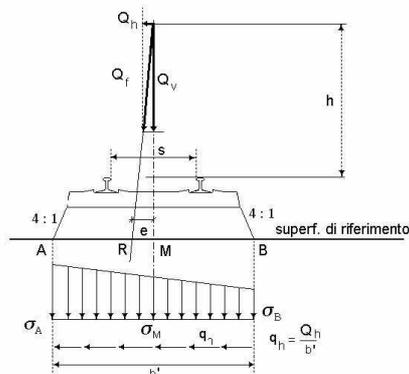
Distribuzione trasversale in rettilo delle azioni per mezzo delle traverse e del ballast. In figura, Q_h rappresenta la forza centrifuga definita al successivo §5.2.2.3.1
